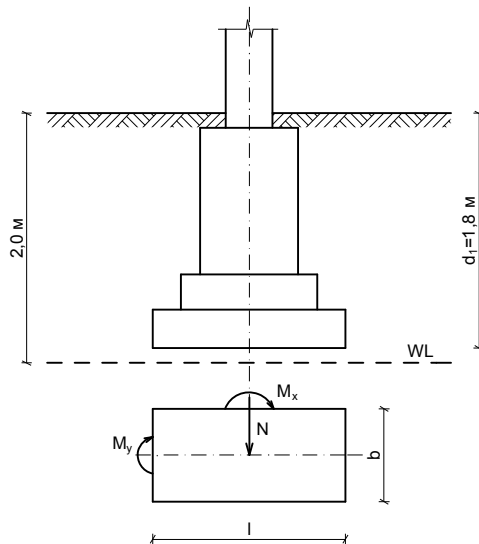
Схема розташування фундаменту у ґрунті і навантажень на фундамент
